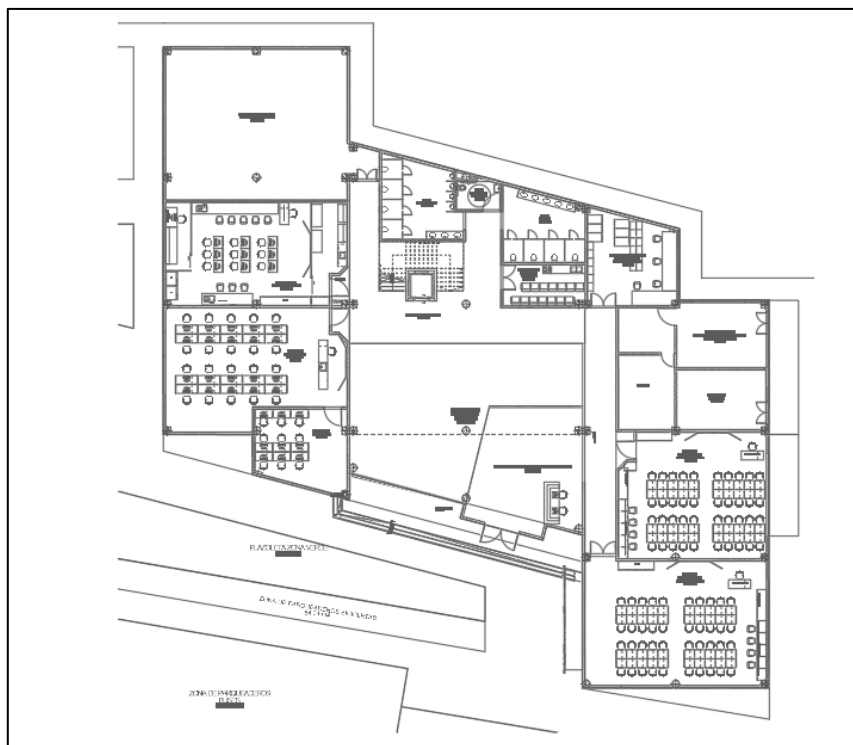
Plantas Arquitectónicas del proyecto Nivel 1.
